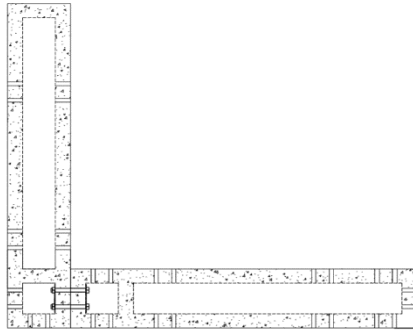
13 Sambungan Balok dengan Kolom Tipe 2
